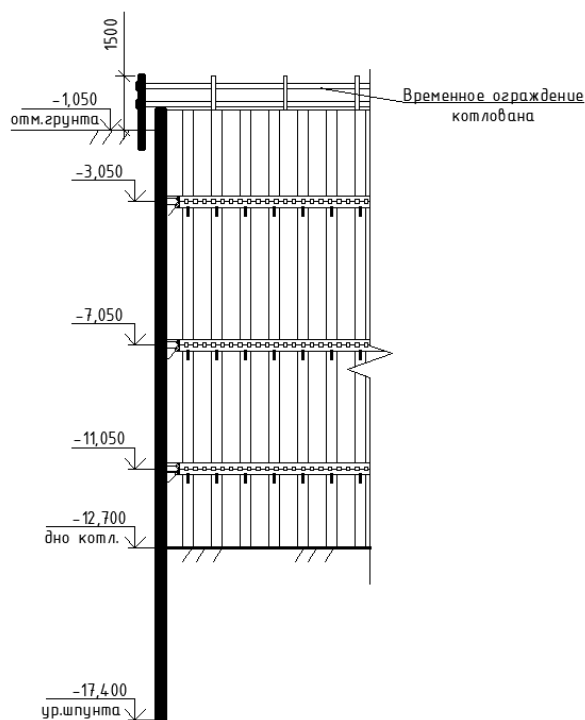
Схема устройства шпунтового ограждения котлована
